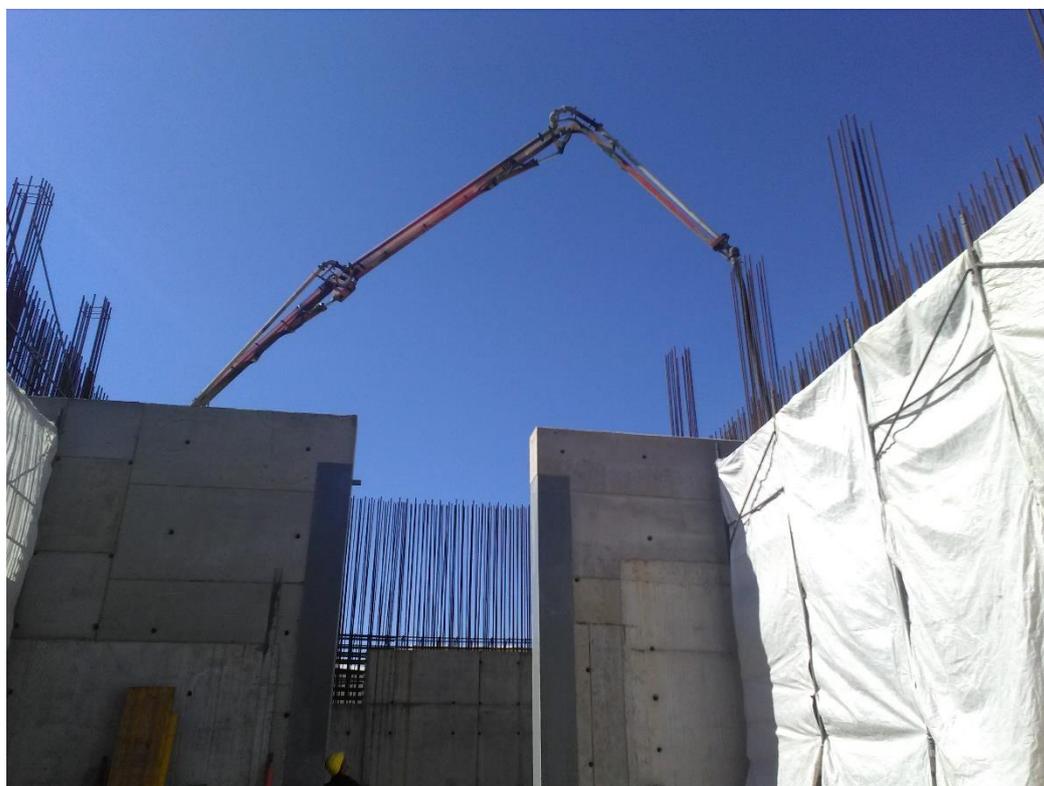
Foto di cantiere durante il getto delle strutture in elevazione
